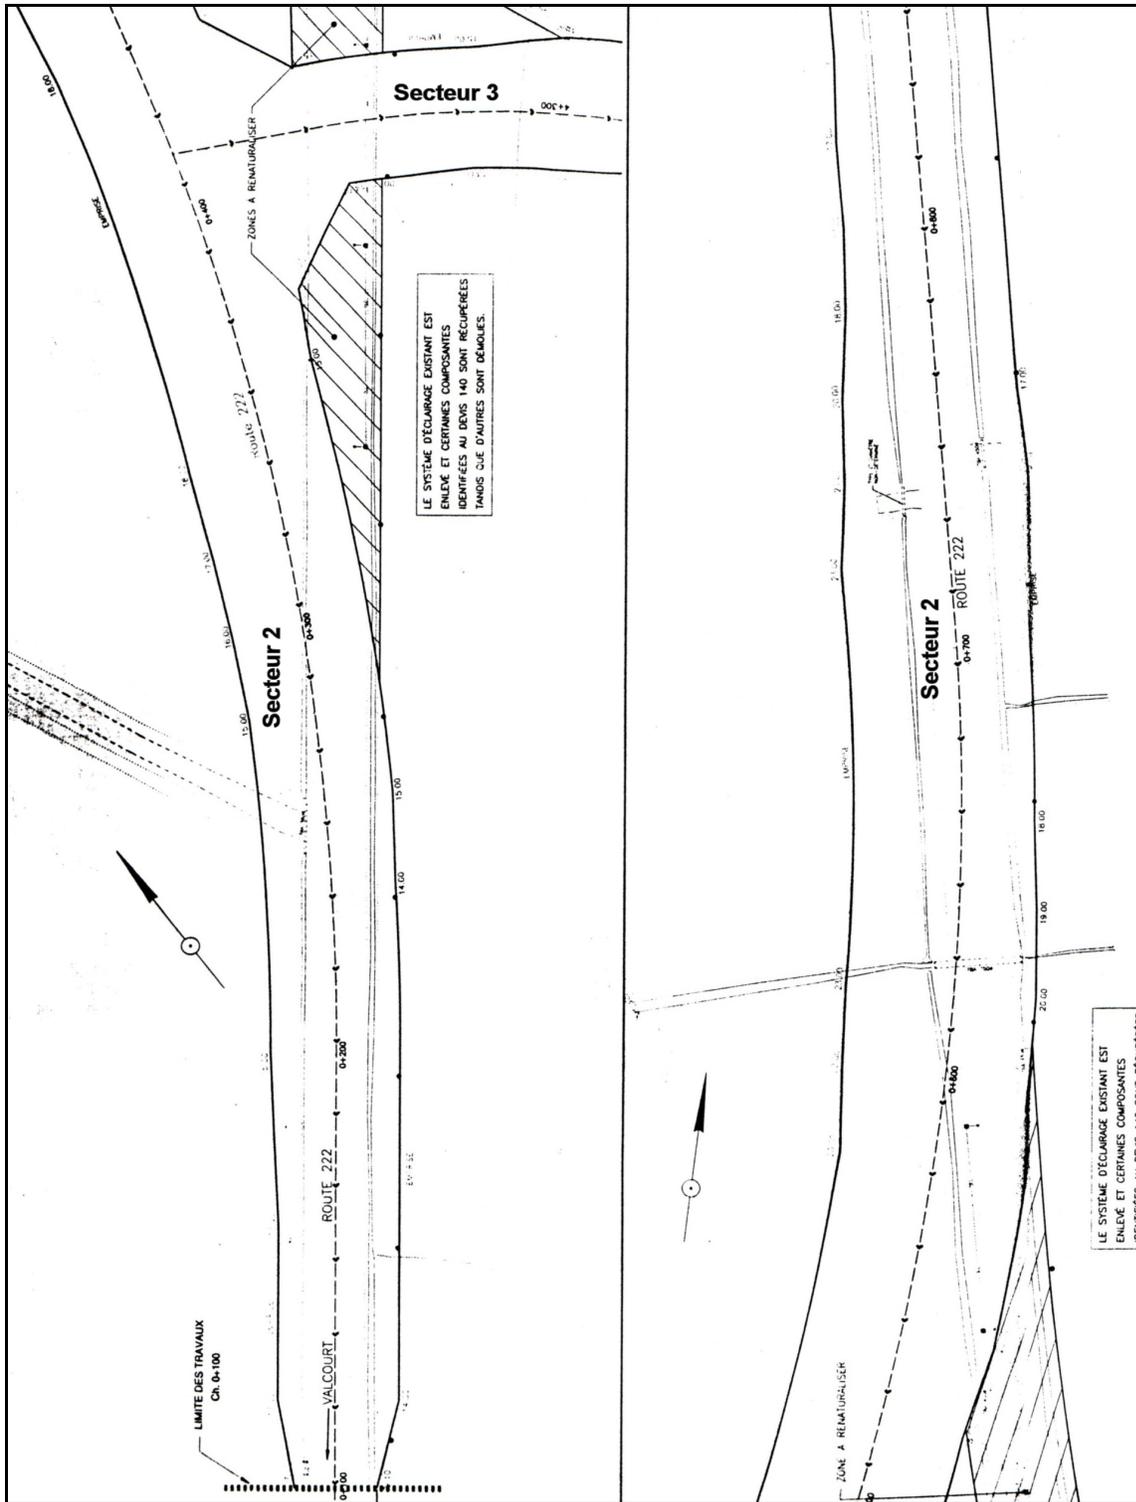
Localisation des secteurs d'inventaire sur le plan de construction du projet 20-6100-9824, routes 222 et 243 (2/3)
